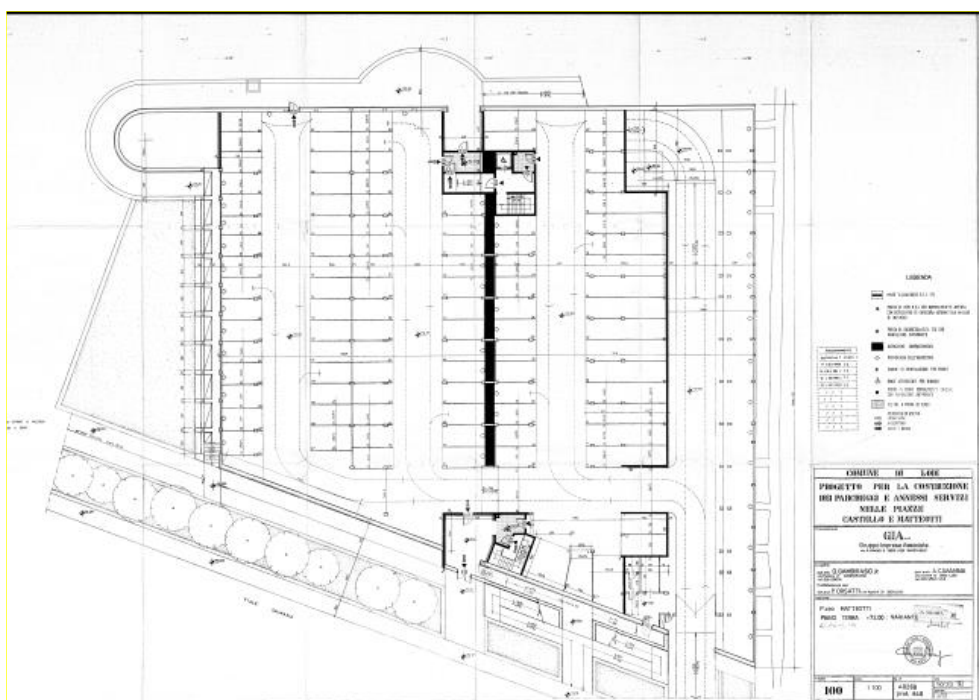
Pianta Piano terra parcheggio Piazza Matteotti
